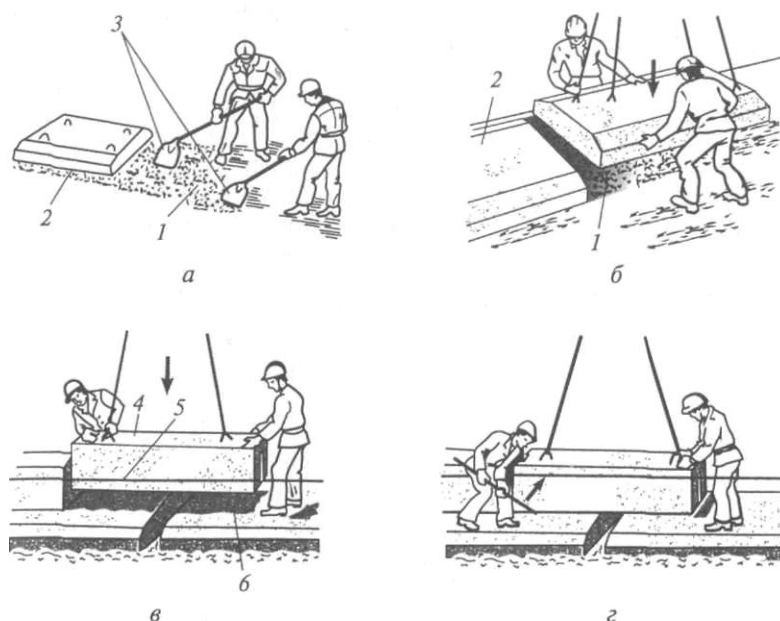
Установка сборных элементов фундаментов: а — подготовка песчаного основания; б — установка железобетонной подушки фундамента; в — установка стеновых блоков; г — выверка в плане стенового блока; 1 — песчаное основание; 2 — установленный элемент; 3 — лопата; 4 — стеновой блок; 5 — осевая проволока; 6 — растворная постель
